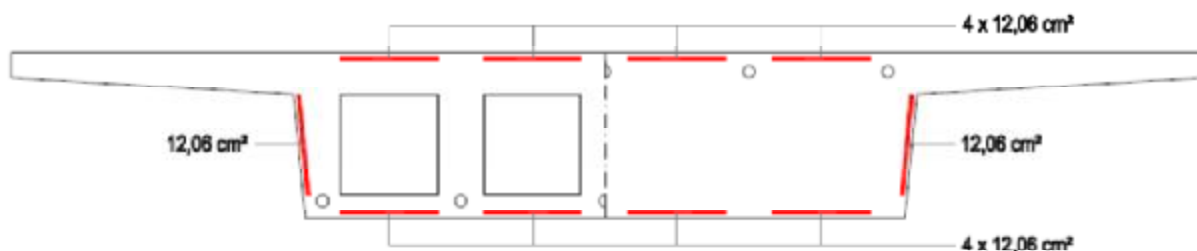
Esquematização das armaduras longitudinais de torção em todas as secções do tabuleiro
